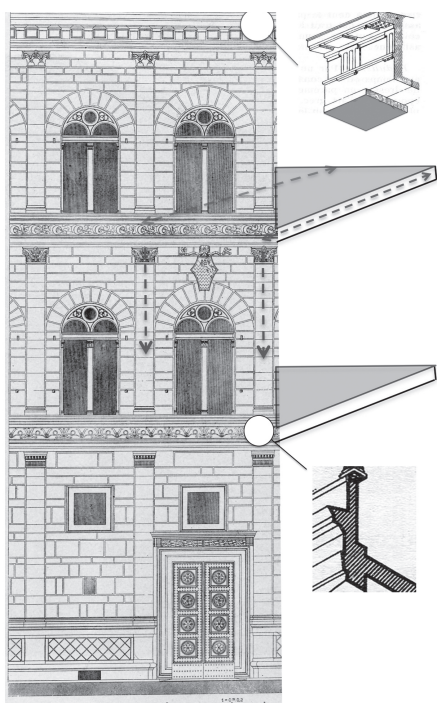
Alberti. Palais Rucellai. Pilastres, renforts de soutien des planchers. Corniches de protection pluviale
